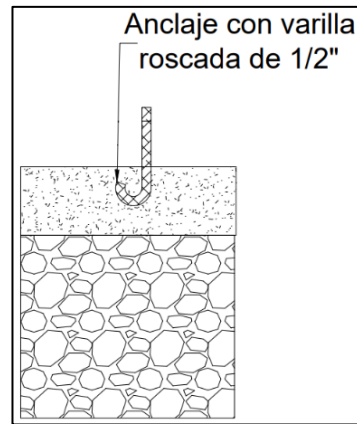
Propuesta de sobrecimentación en vivienda de Resgarde de Pitayó.
